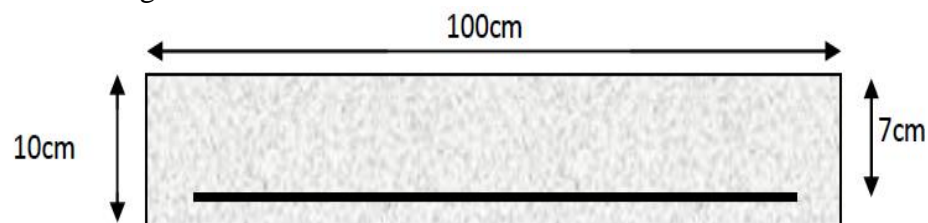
Section transversale à ferrailer de l'acrotère
